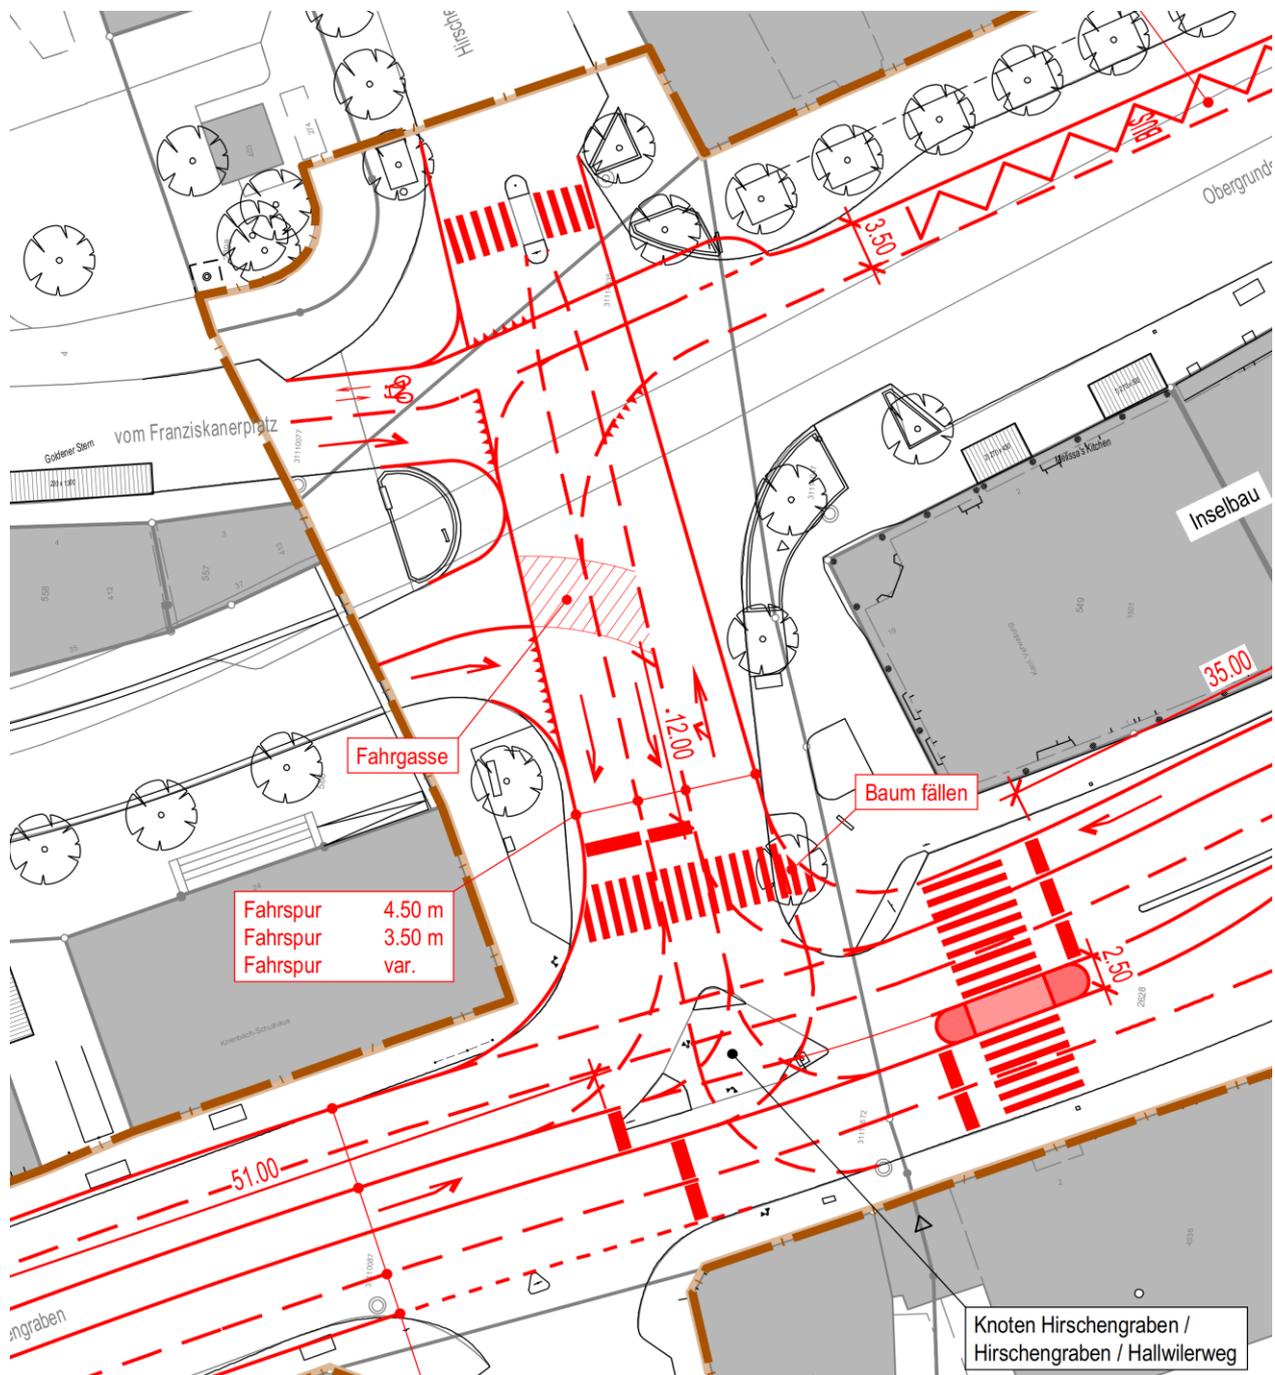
Detail zur Erschliessung der Kleinstadt in der Variante B
